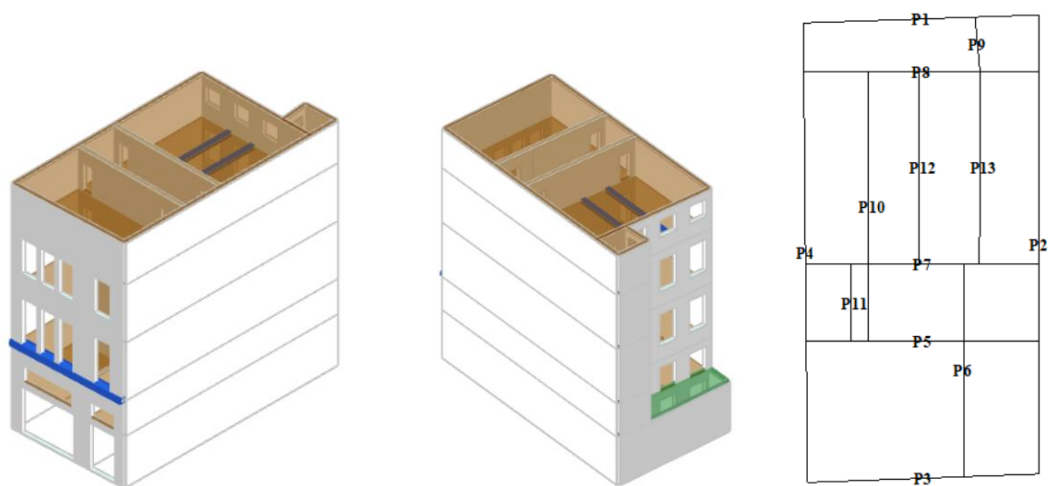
Modelo Rua Alexandre Braga e planta respetiva
